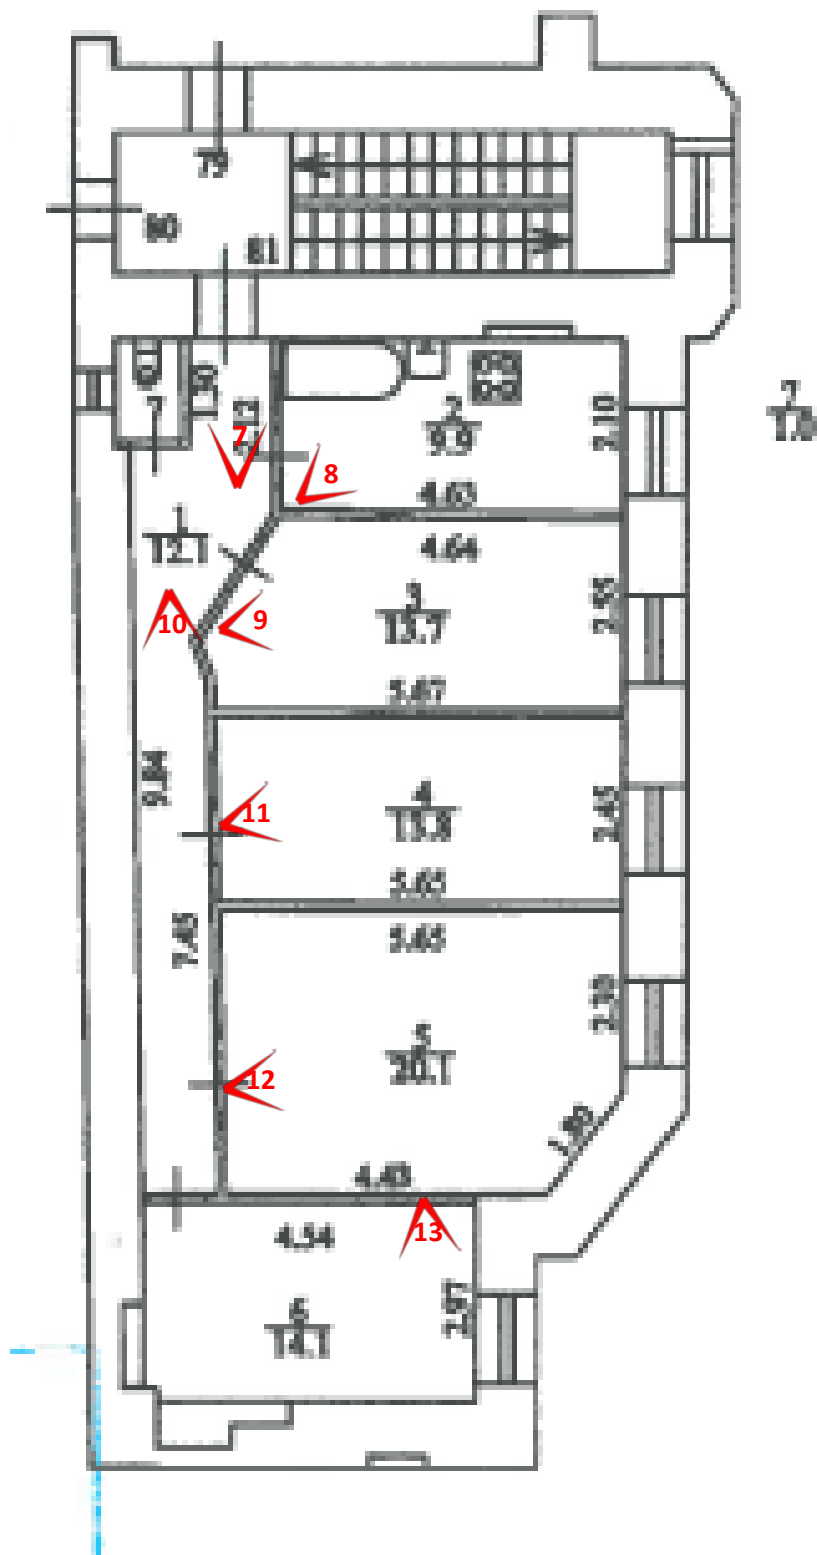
Схема фотофиксации на фрагменте плана 4 этажа
